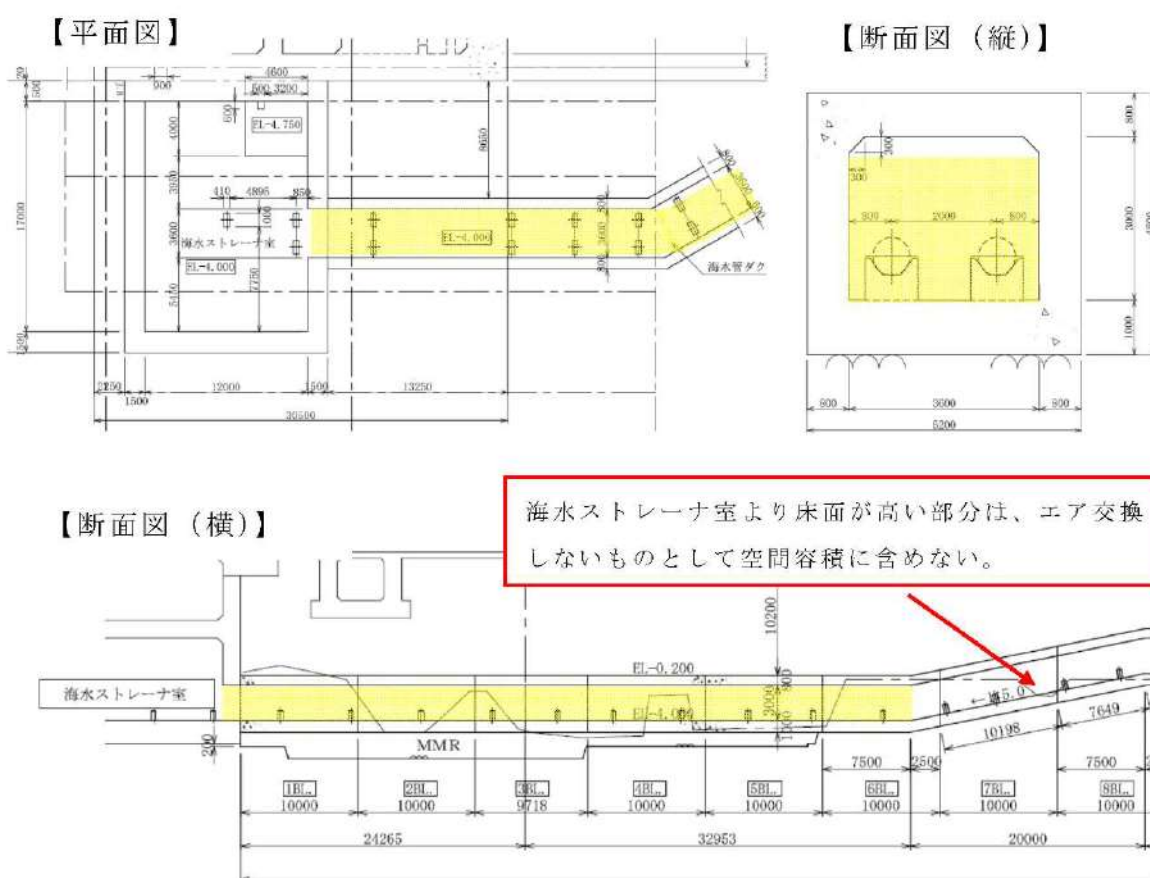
原子炉補機冷却海水管ダクト平面図及び断面図
